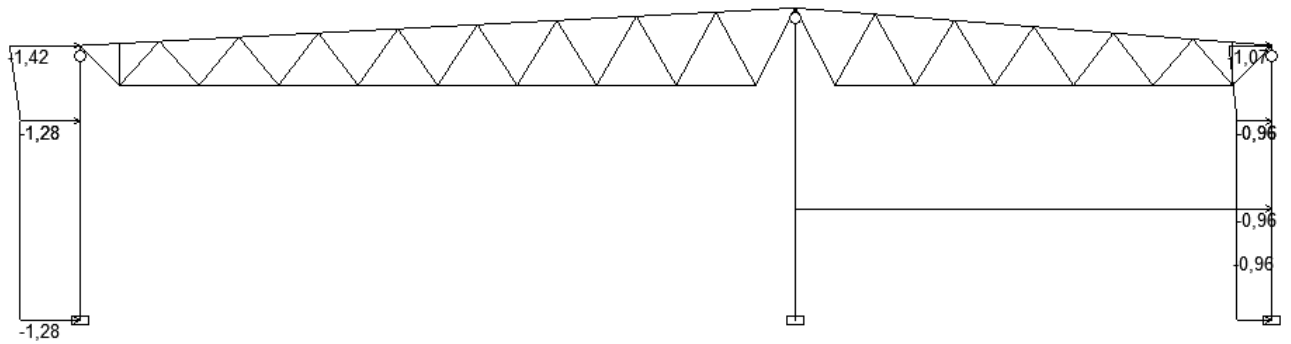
Схема загрузки от ветровых нагрузок
